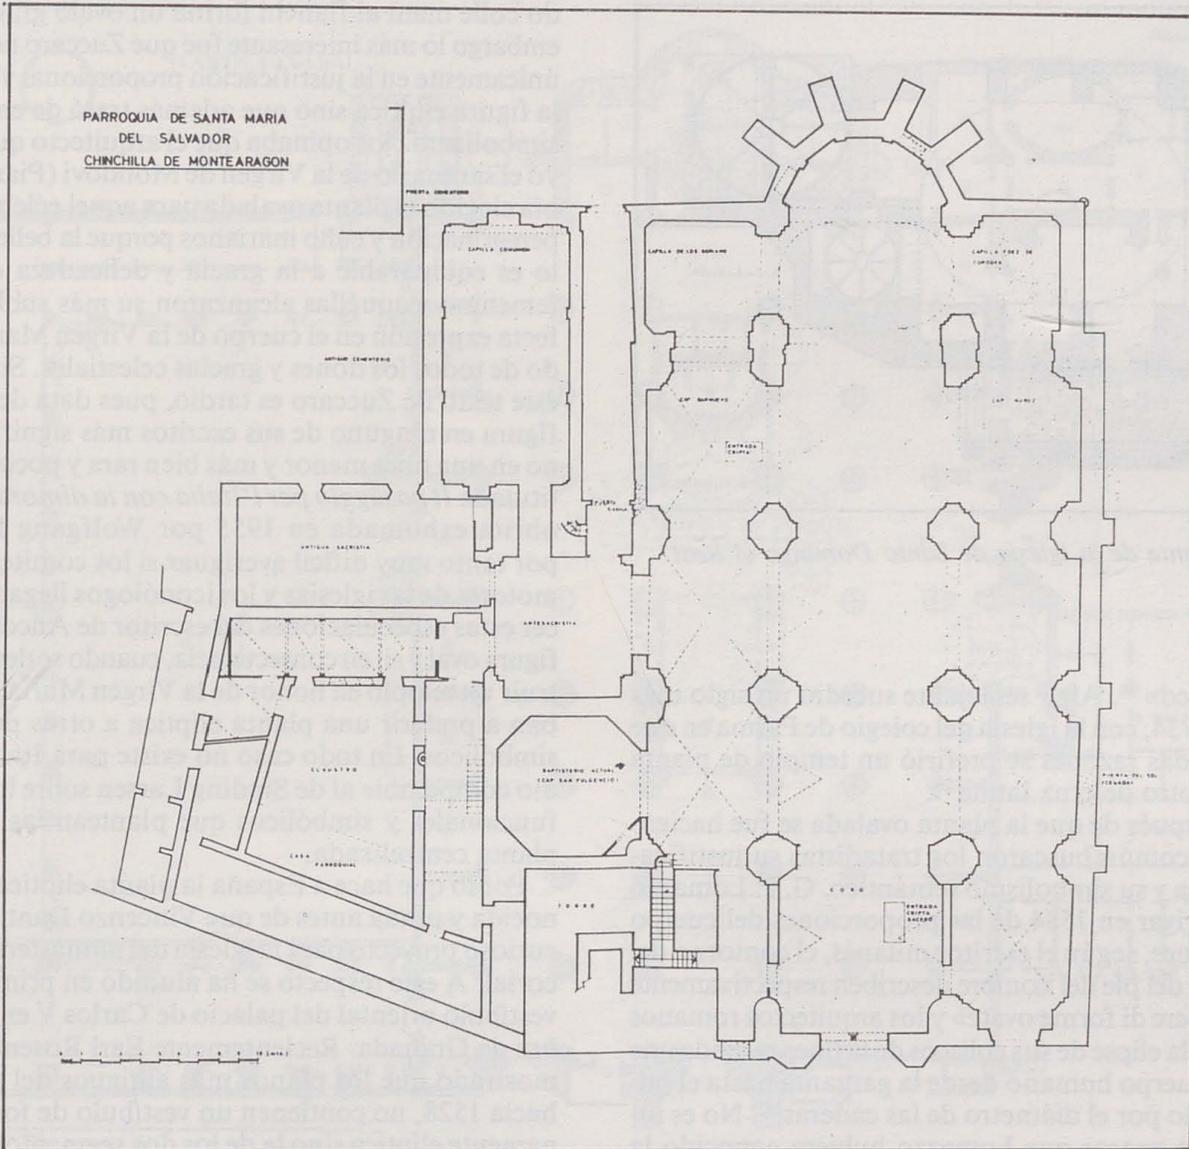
J. Quijano: planta de Santa María de Chinchilla.
